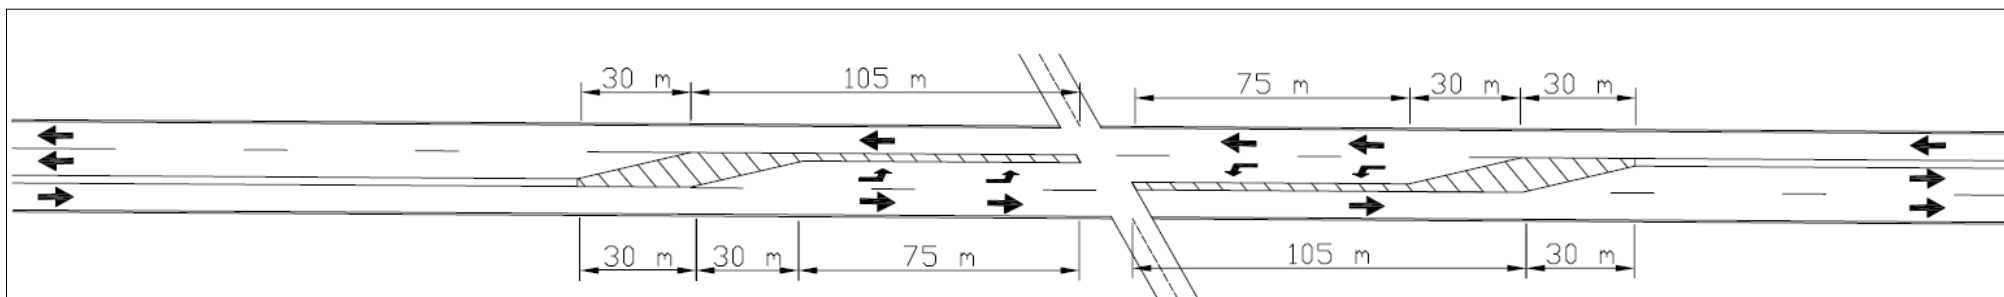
(intersecție cu zonă de alternanță de la 1 bandă pe sens la două benzi pe sens)
